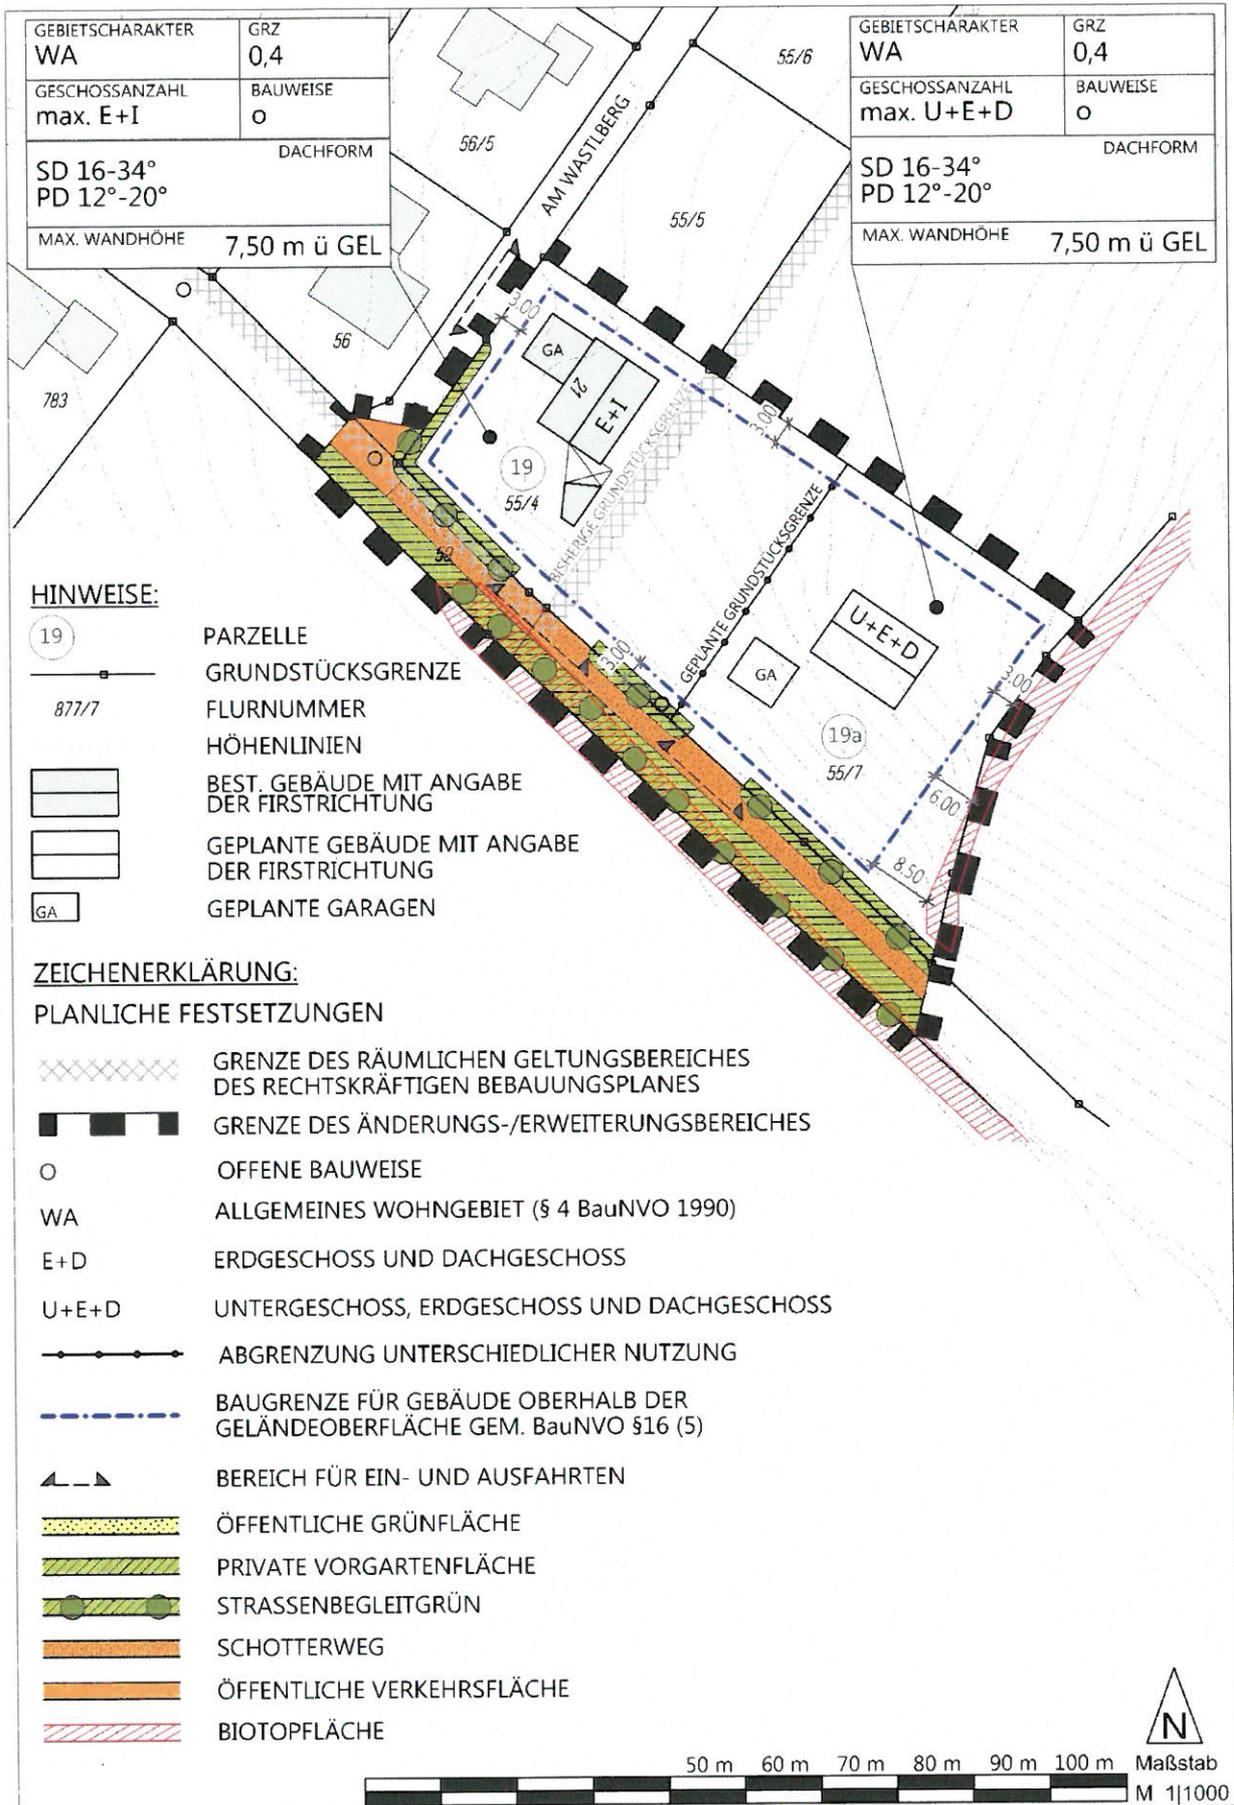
geänderte Bebauungsplandarstellung M 1:1000
